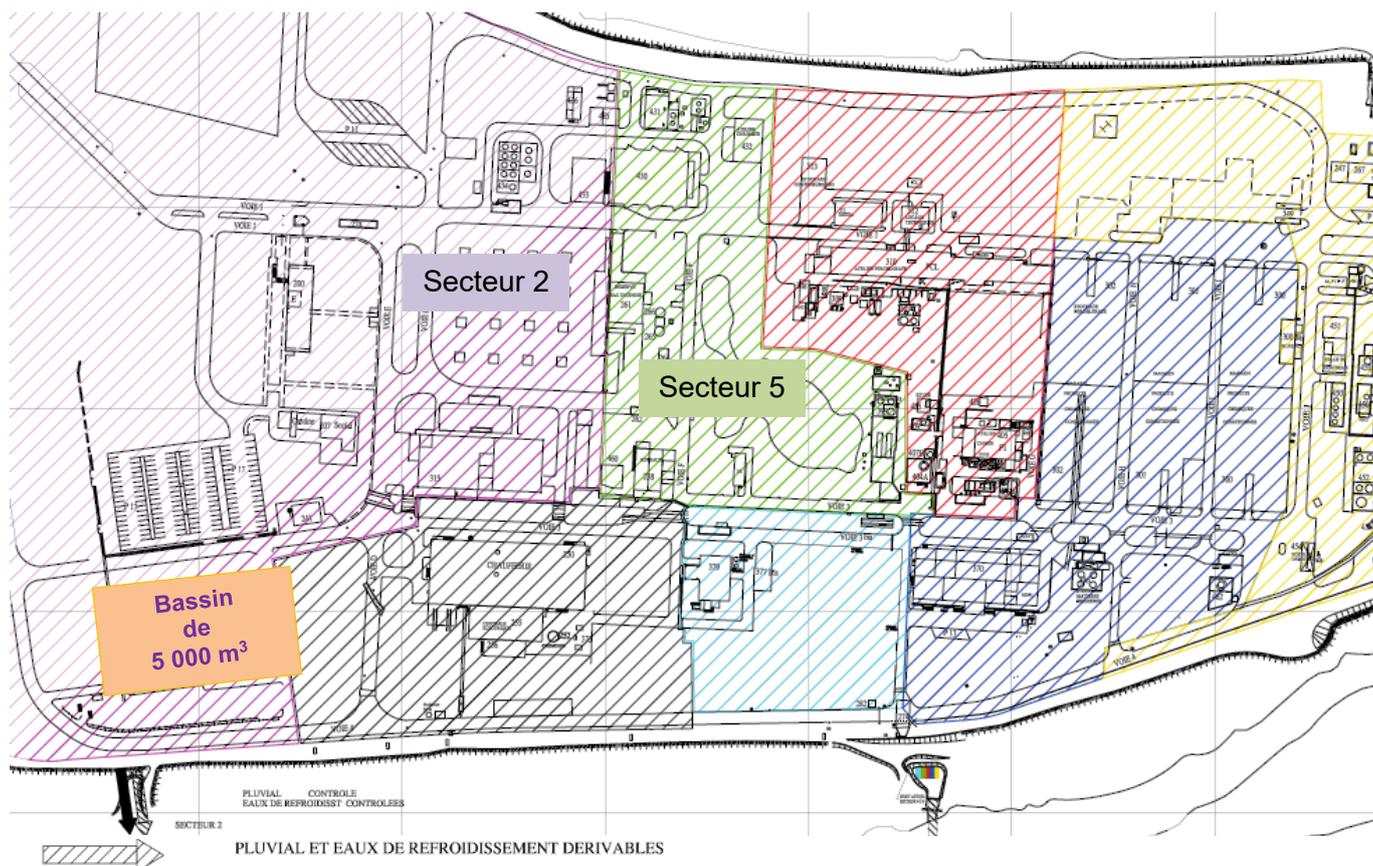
Plan des secteurs pour la gestion des eaux pluviales sur la plateforme
